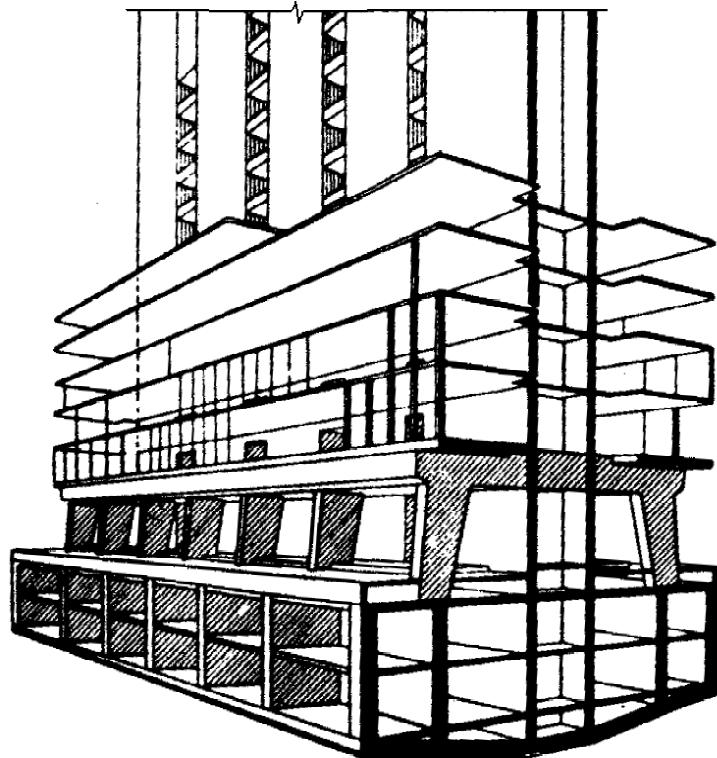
Высотное здание с жестким коробчатым фундаментом.
